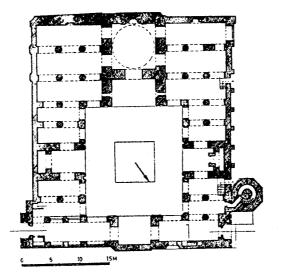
مسقط أفقي للجامع الأزرق في تبريز. (عن: Pope).
